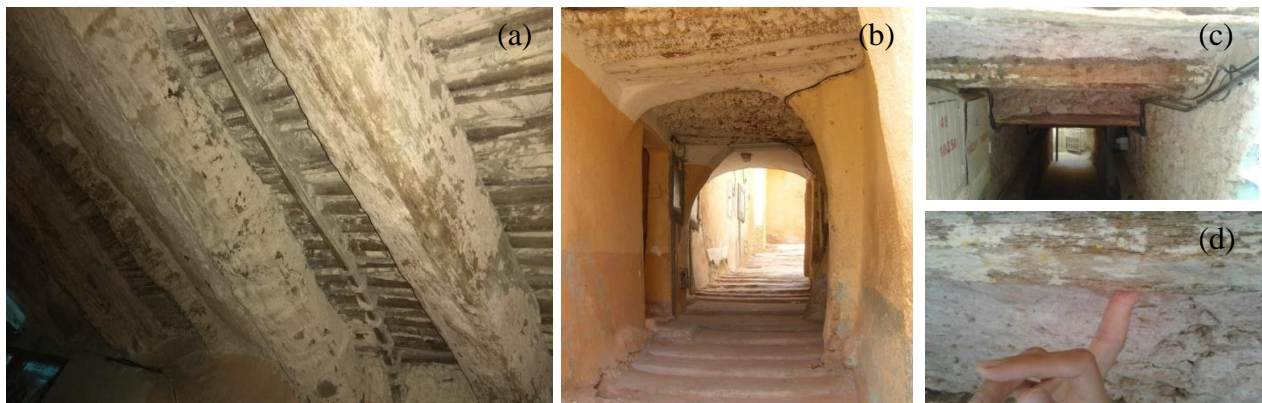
Photos d'un plancher en troncs et branches de palmiers d'un passage couvert du Ksar : (a) plancher dans un passage du Ksar Al-Atteuf ; (b), (c) et (d) plancher dans un passage du Ksar de Béni Isguen (Auteur, 2018)
